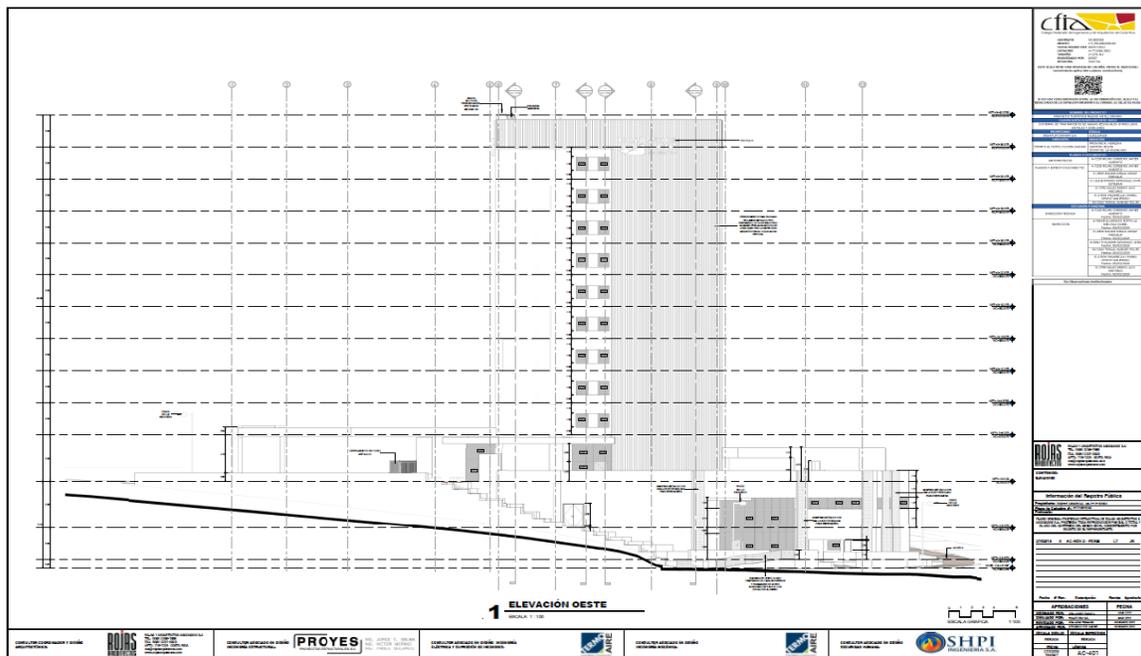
Elevación Lateral Oeste. Proyección de Altura 40.00 metros sobre nivel de calle, lámina # AC-401 de los planos presentados.
